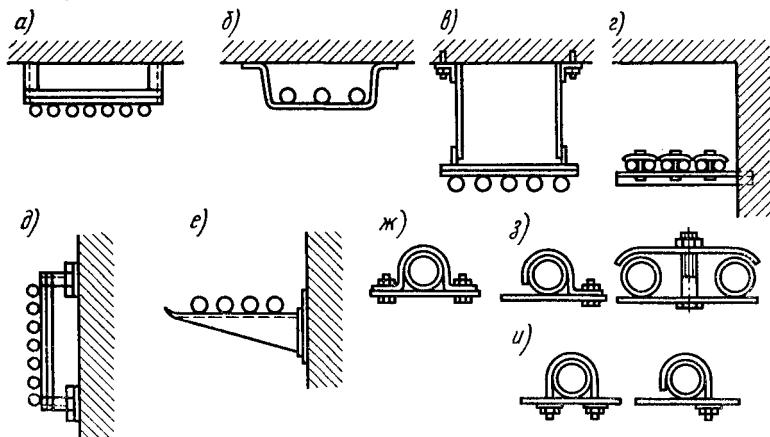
Опорные и крепежные конструкции и детали для трубных электропроводок:
